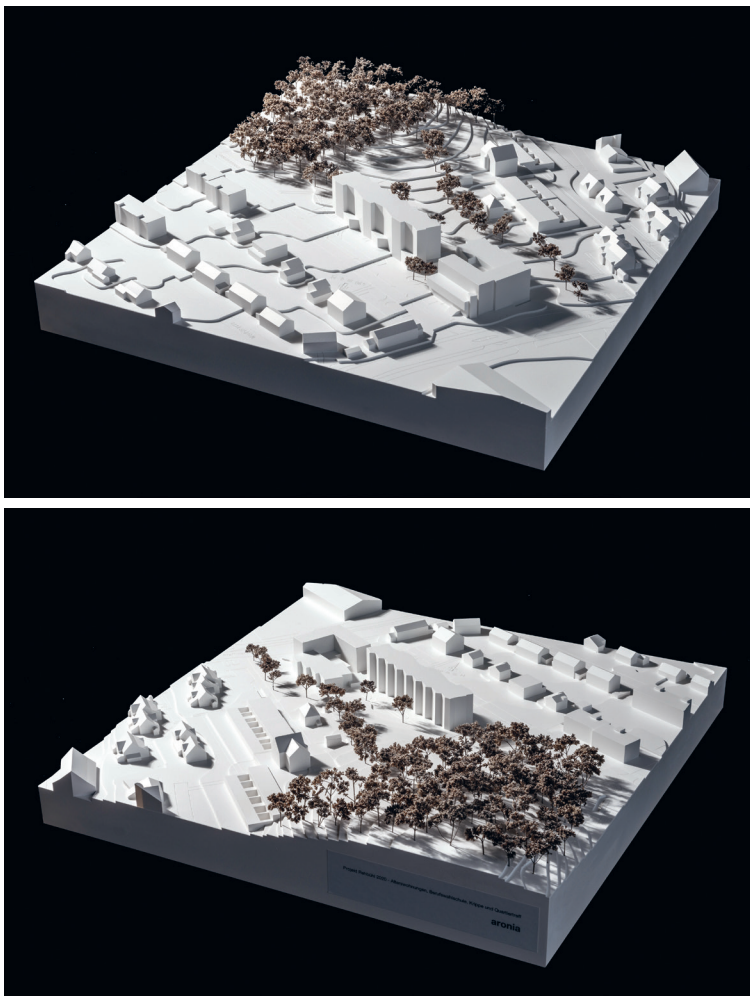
Modellfoto - Stand Wettbewerb November 2014
